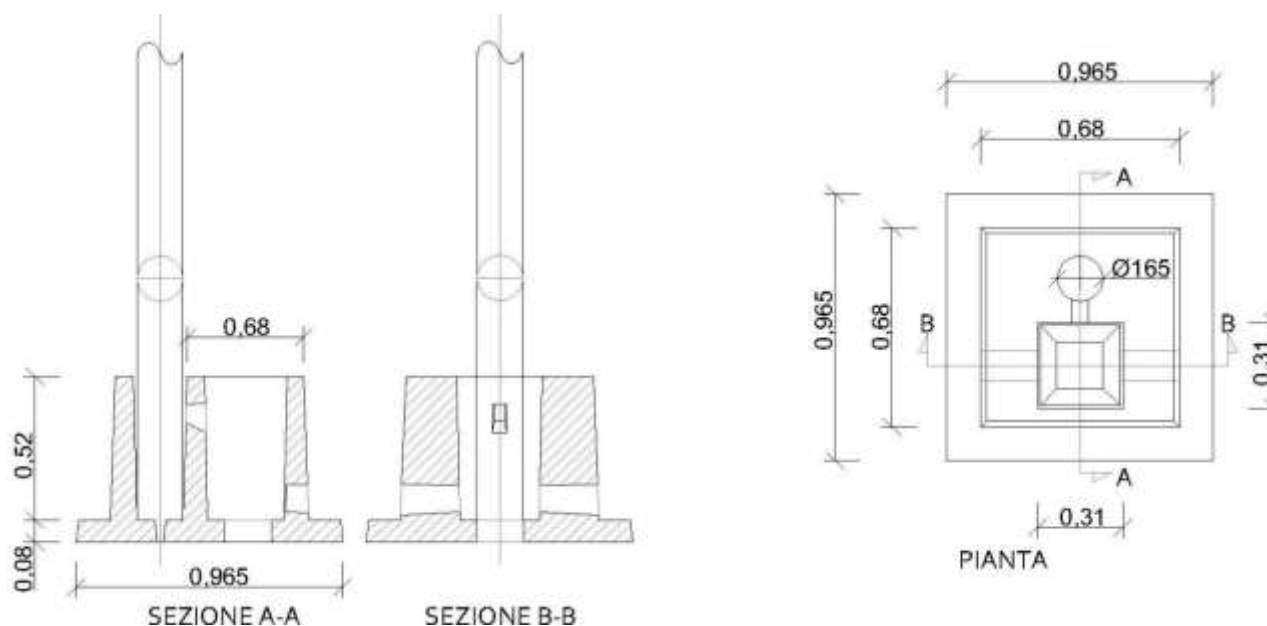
Sezioni e piante della fondazione del palo di illuminazione e videosorveglianza.
